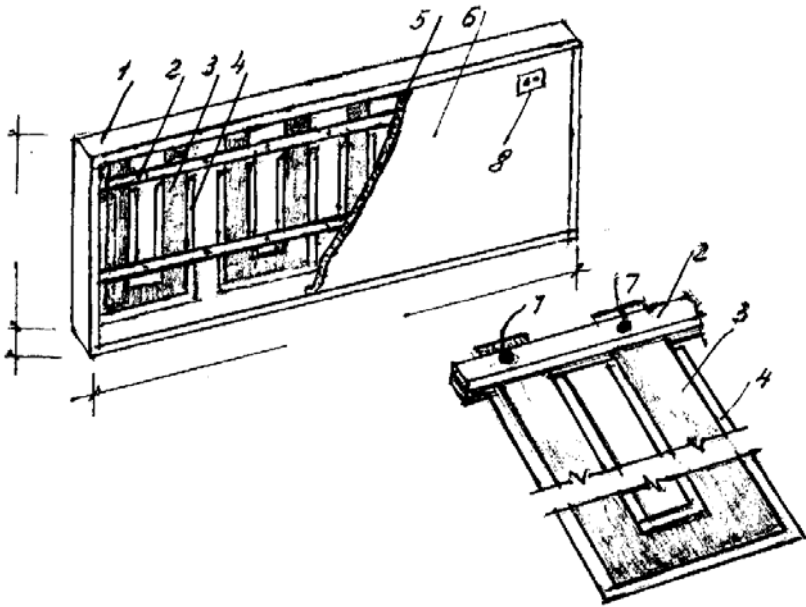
Опалубка с нагревателями из углеродистых лент:
